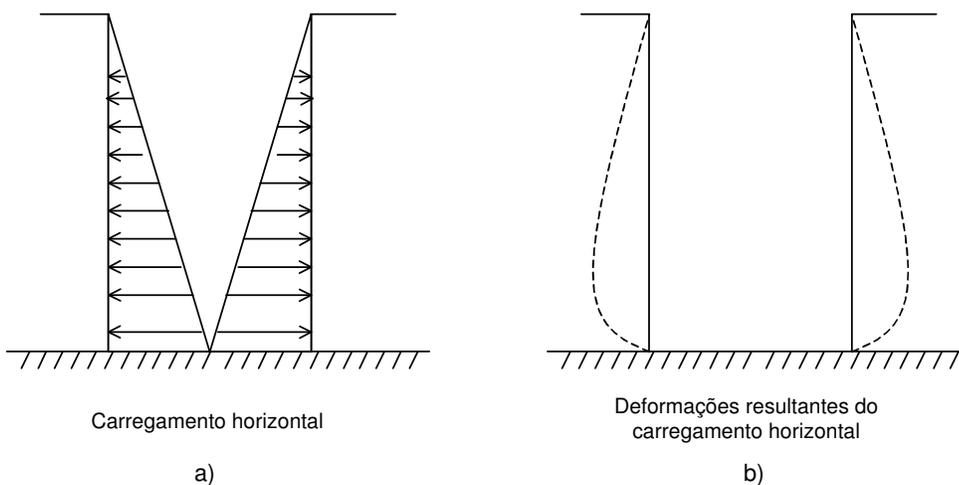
Vista de pilar representando esquematicamente: a) cargas horizontais; b) deformação das fôrmas.
